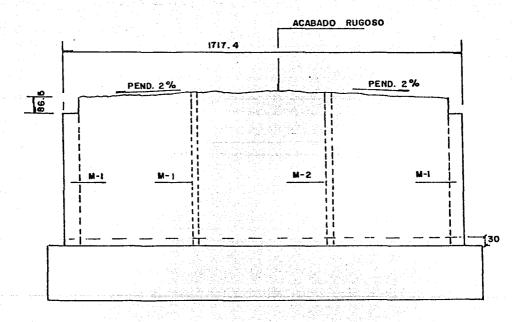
ELEVACION DE MURO TAPON NORTE Y SUR.
